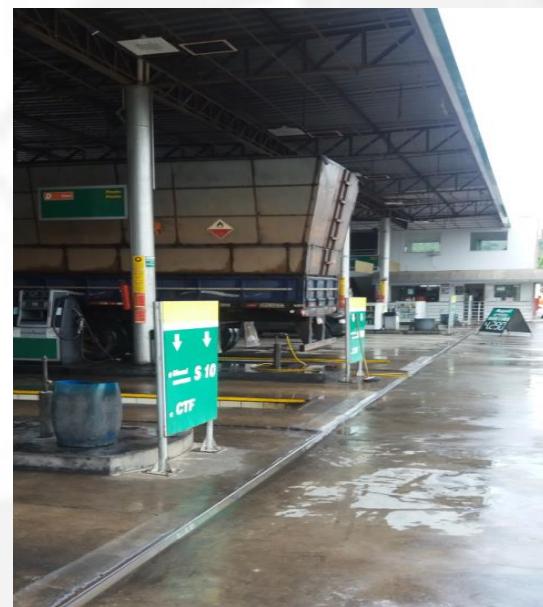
Canaletas de contenção dentro da cobertura da pista de abastecimento.
